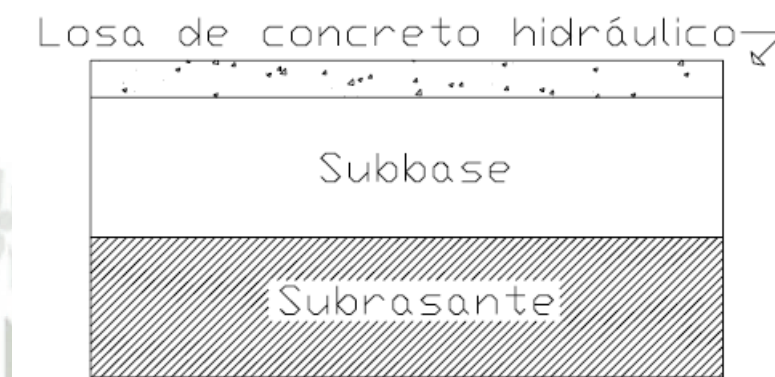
Esquema de comportamiento de Pavimentos
